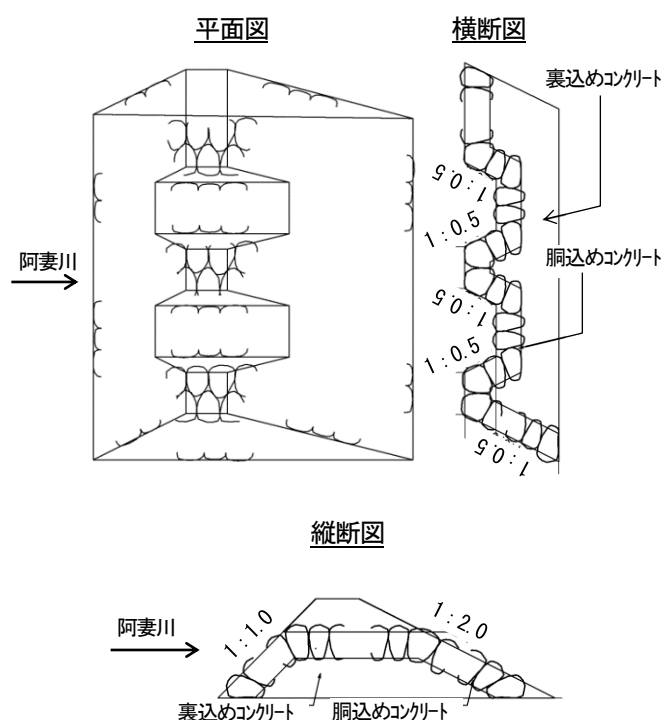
ハイドロバリアー水制構造図（平面・縦断・横断面図）
